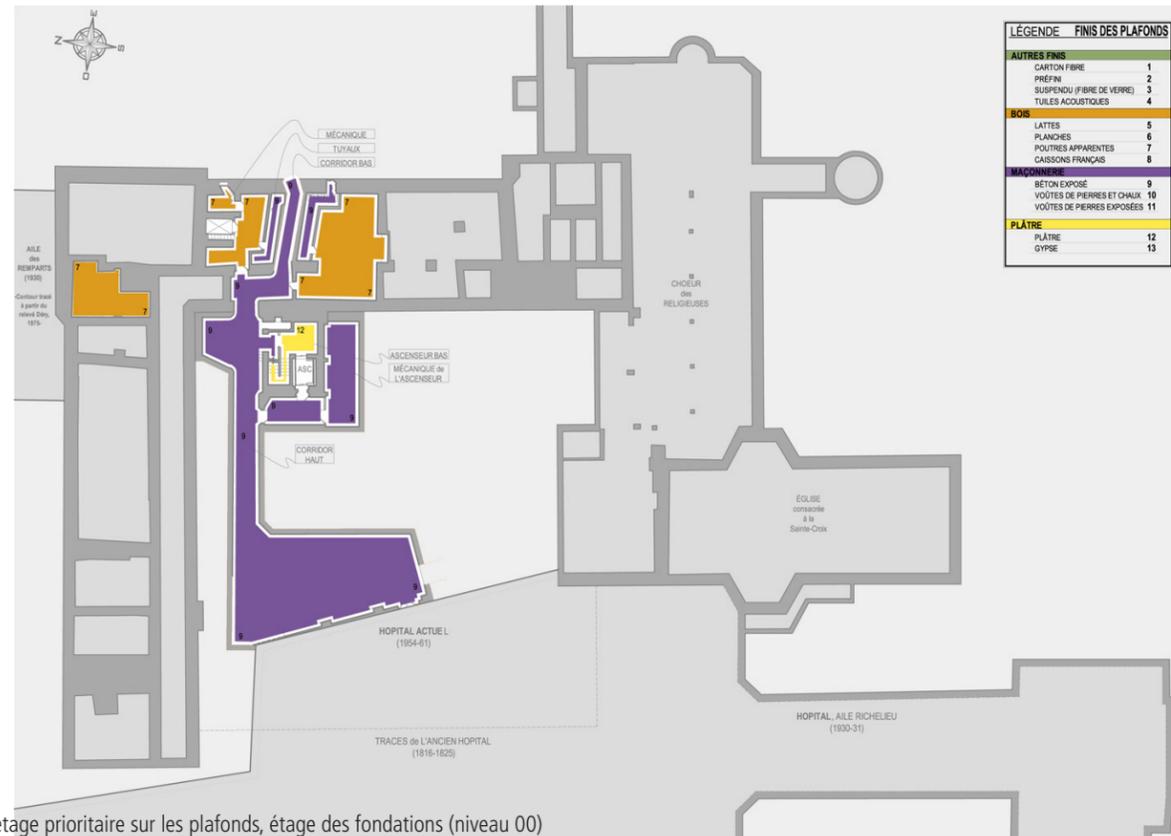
Plan de curetage prioritaire sur les plafonds, étage des fondations (niveau 0)
